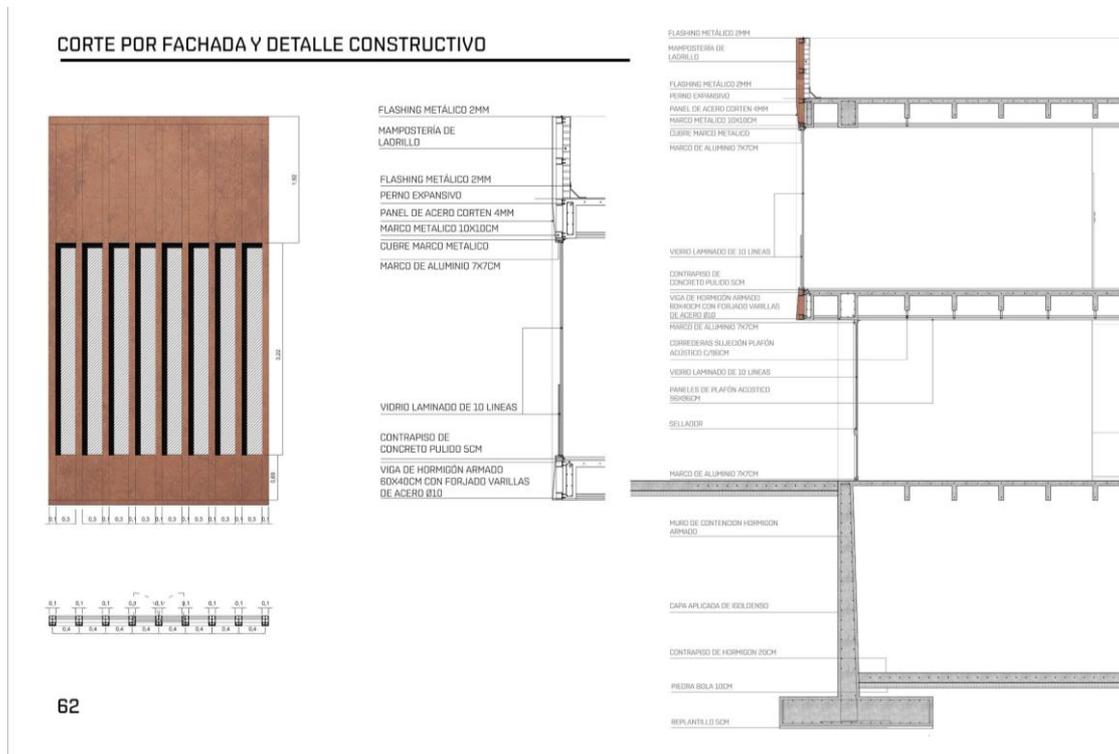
Detalle constructivo de la fachada. Elaborado por: María Beatriz Moncayo
